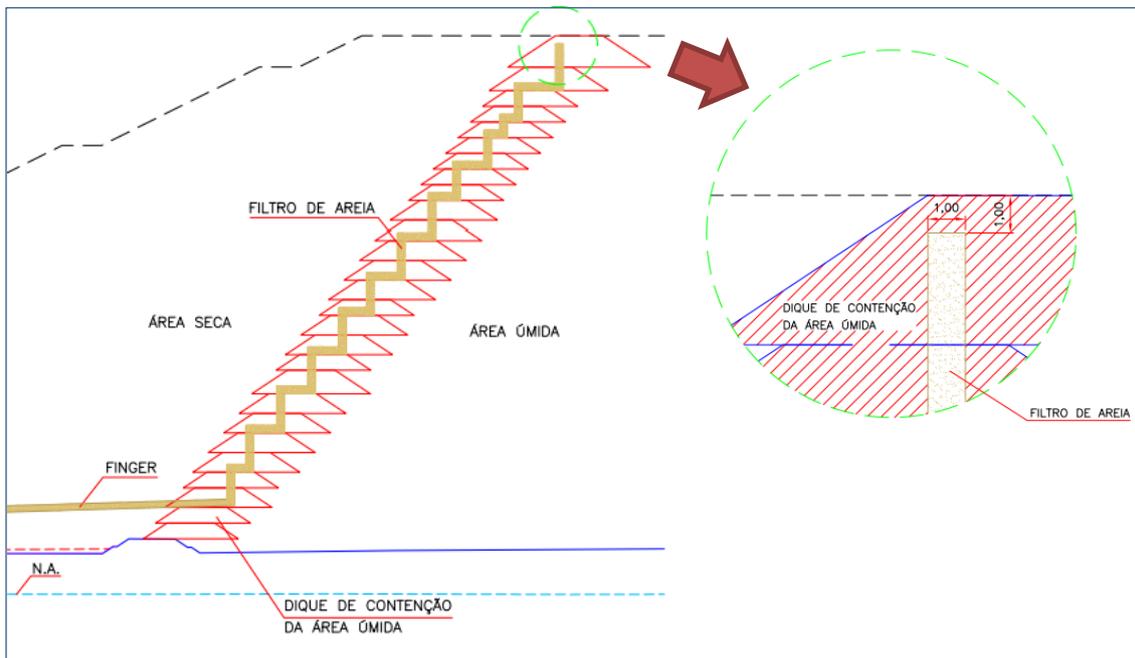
Detalhe do dreno sub-vertical (D1-3541-54-G-163)
